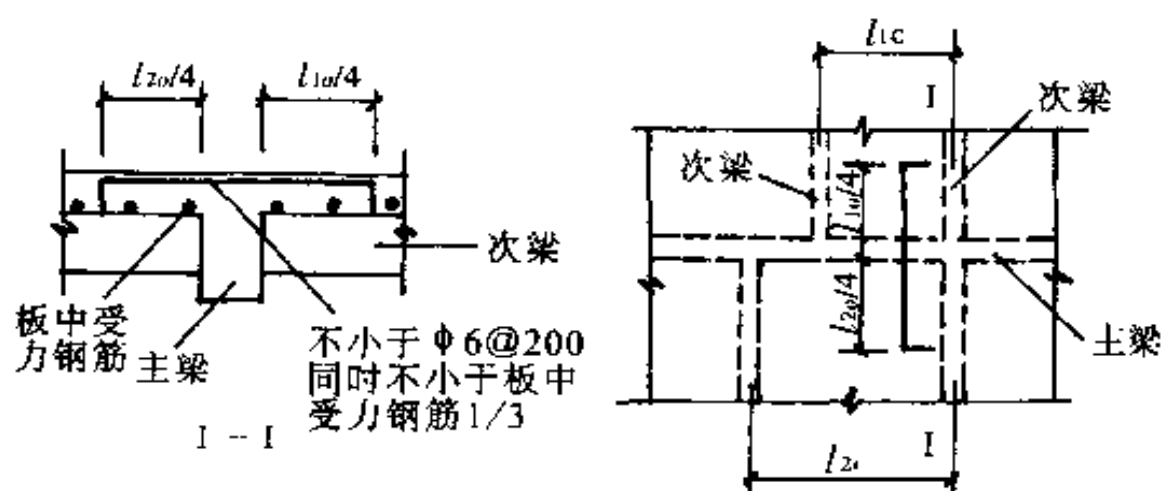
板的受力钢筋与梁肋部平行时构造钢筋的配置
